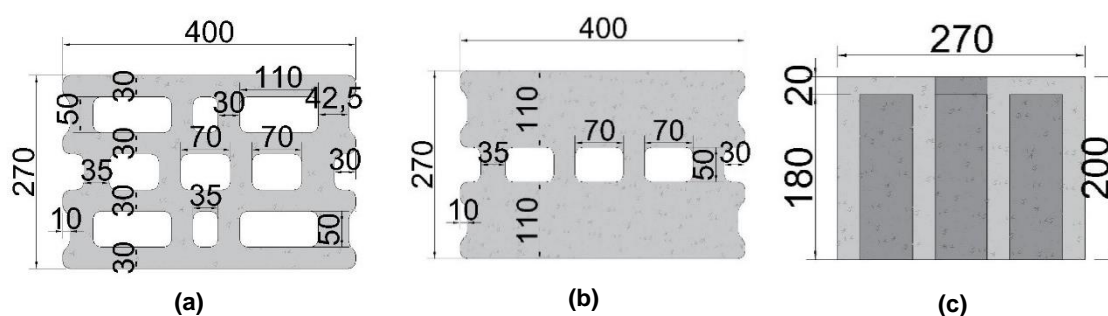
Dimensões dos blocos: (a) Vista inferior; (b) Vista superior; (c) Lado do bloco em corte (dimensões em mm).
